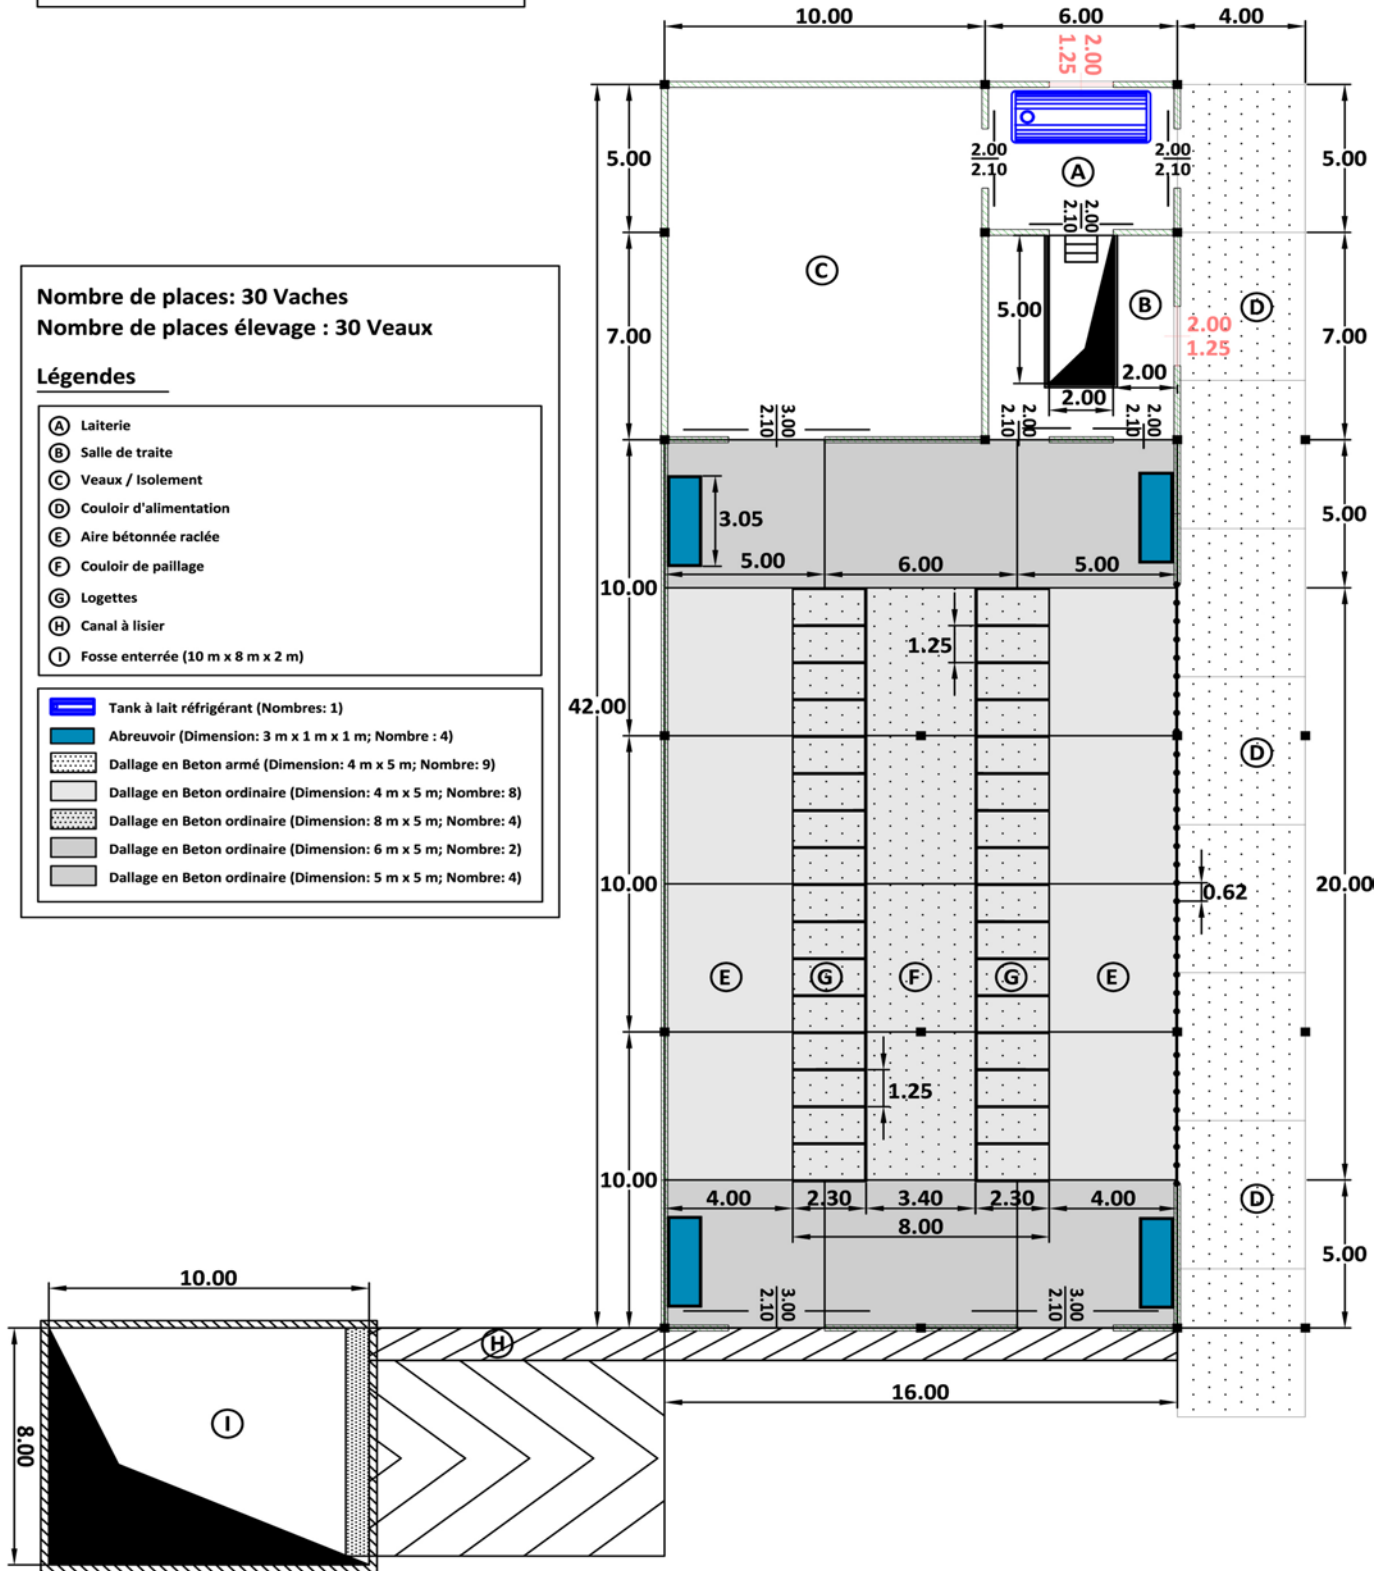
Exemple de plan type d'une étable longitudinale à logettes (stabulation libre) – cas d'une étable pour 30 vaches.
